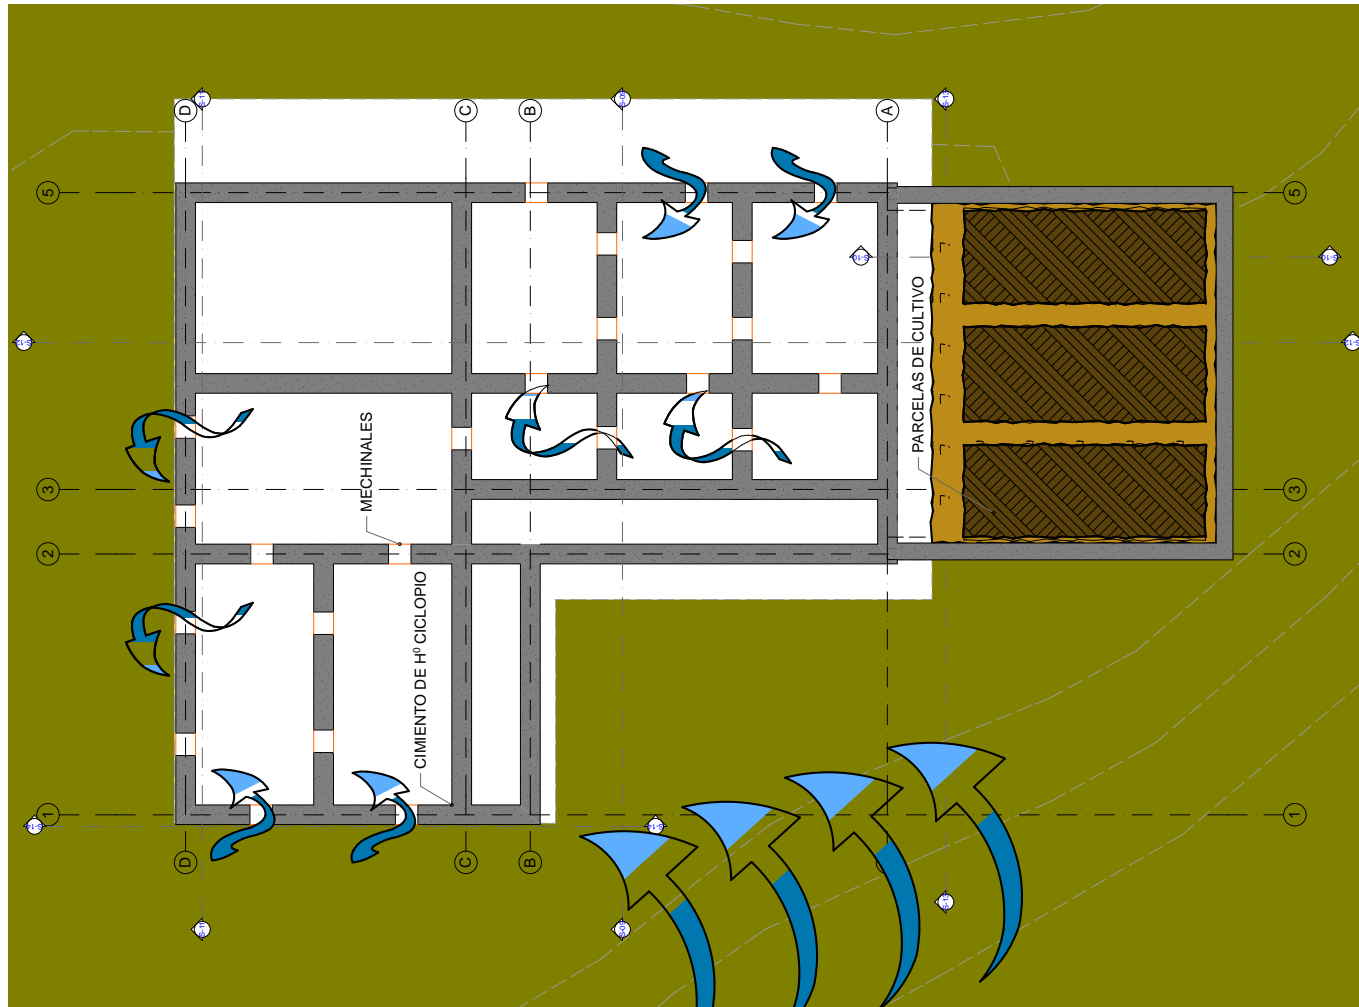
PLANTA DE CIMENTACION PROPUESTA
